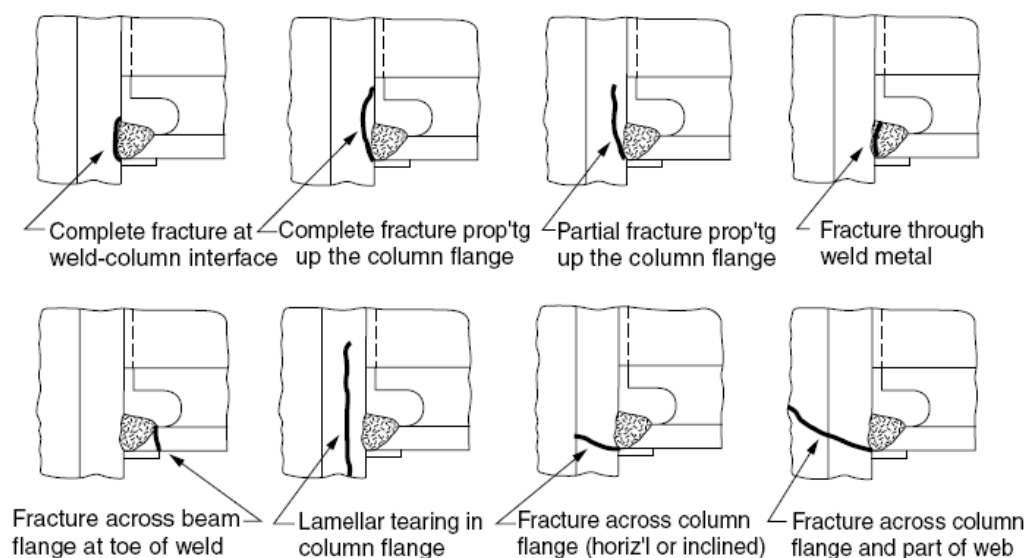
modes de ruptures observés au niveau de la soudure de la semelle inférieure de la poutre et la semelle du poteau durant le séisme de Northridge 1994.
